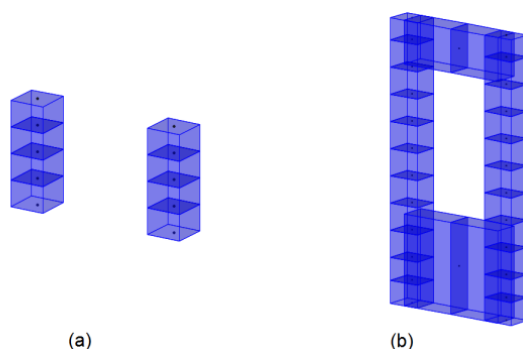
Vista tridimensional dos modelos dos pilares: (a) Pilar P1; (b) Pilar P2
